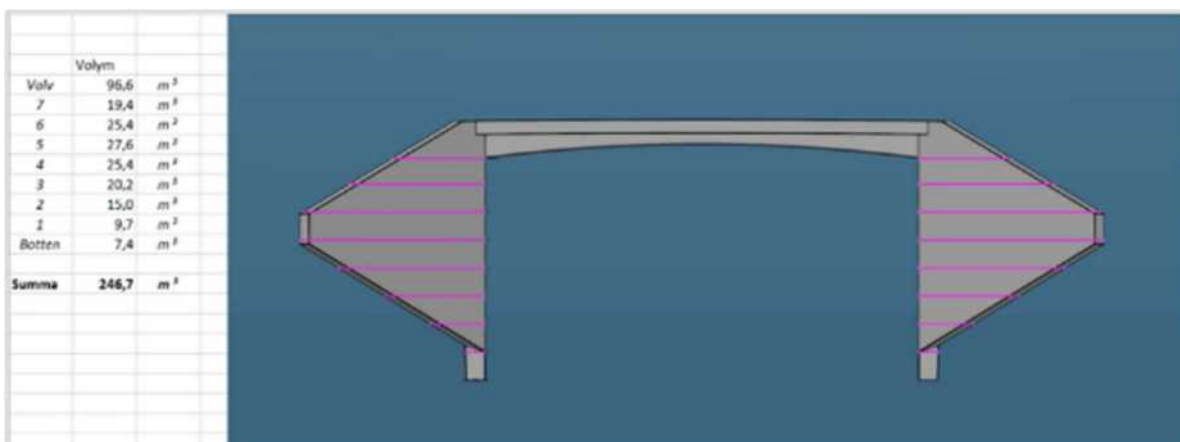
Visar möjligt stag och slangplanering vid ramben för bro med högt ramben.
